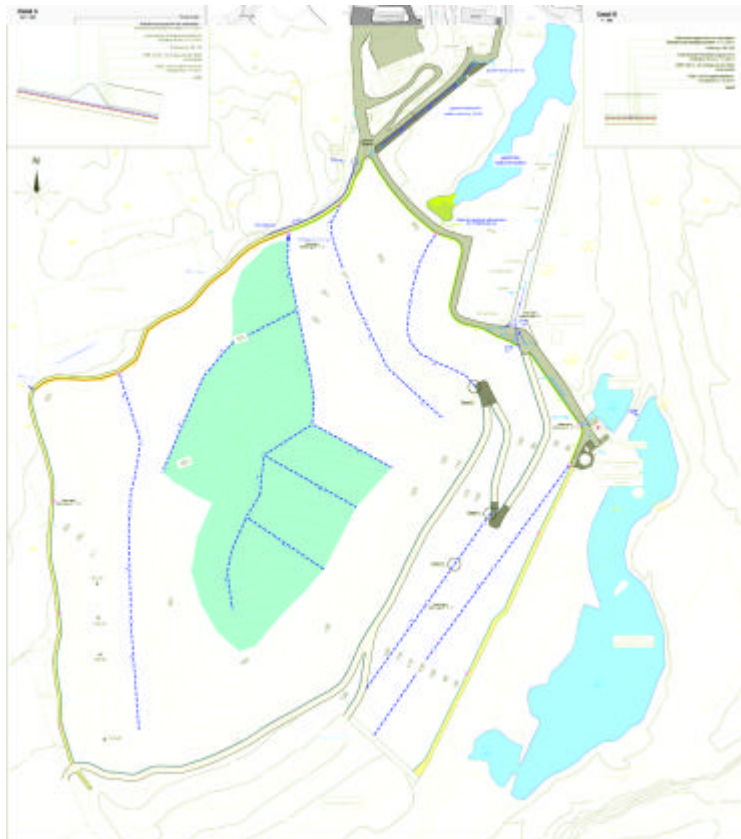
Lageplan Kontrollfläche Wasserbilanz
